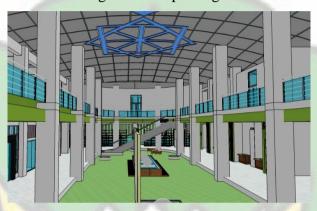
Konsep *Open Plan* (Sumber : Pribadi, 2021)
